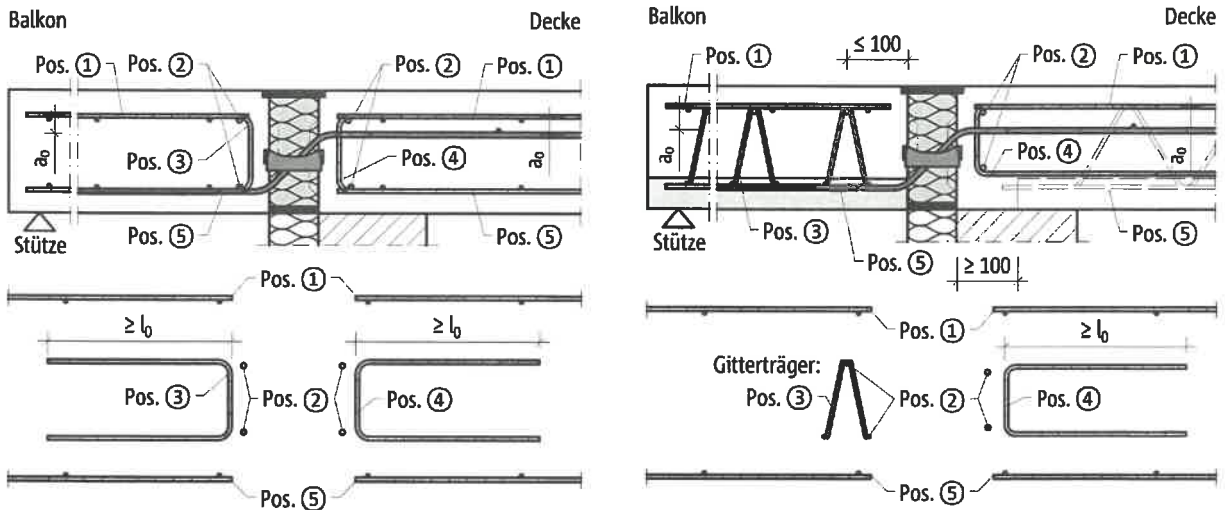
Schöck Isokorb® T Typ Q-V6 bis -V12 6.0, direkte Lagerung: Bauseitige Bewehrung bei Ortbetonbauweise (links) und Fertigteilbauweise (rechts) schematisch dargestellt
